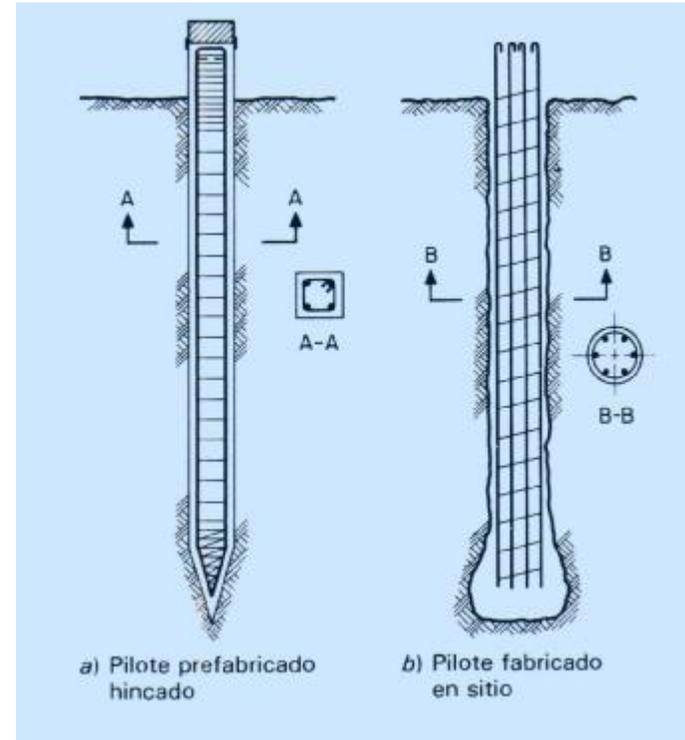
Pilotes hincados y pilotes colados en perforación previa.
